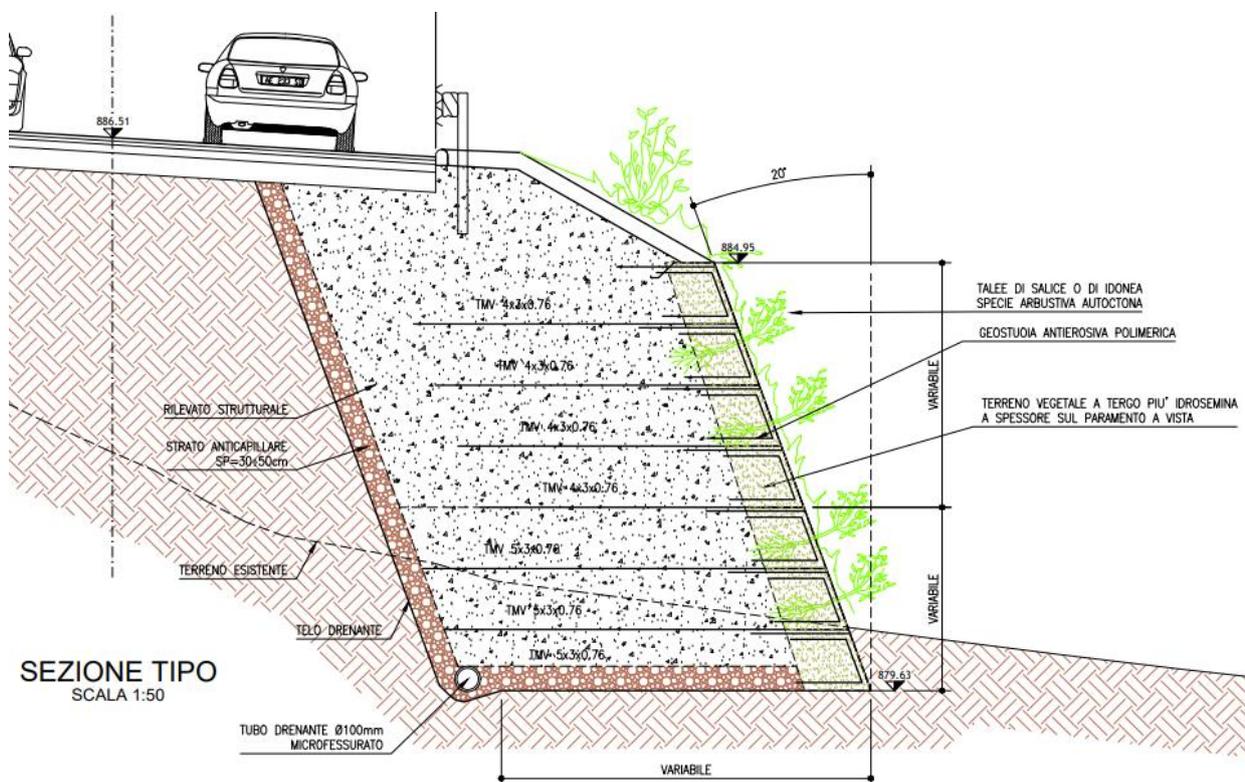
Sezione tipo Muro in terra rinforzata (WBS TA301)
